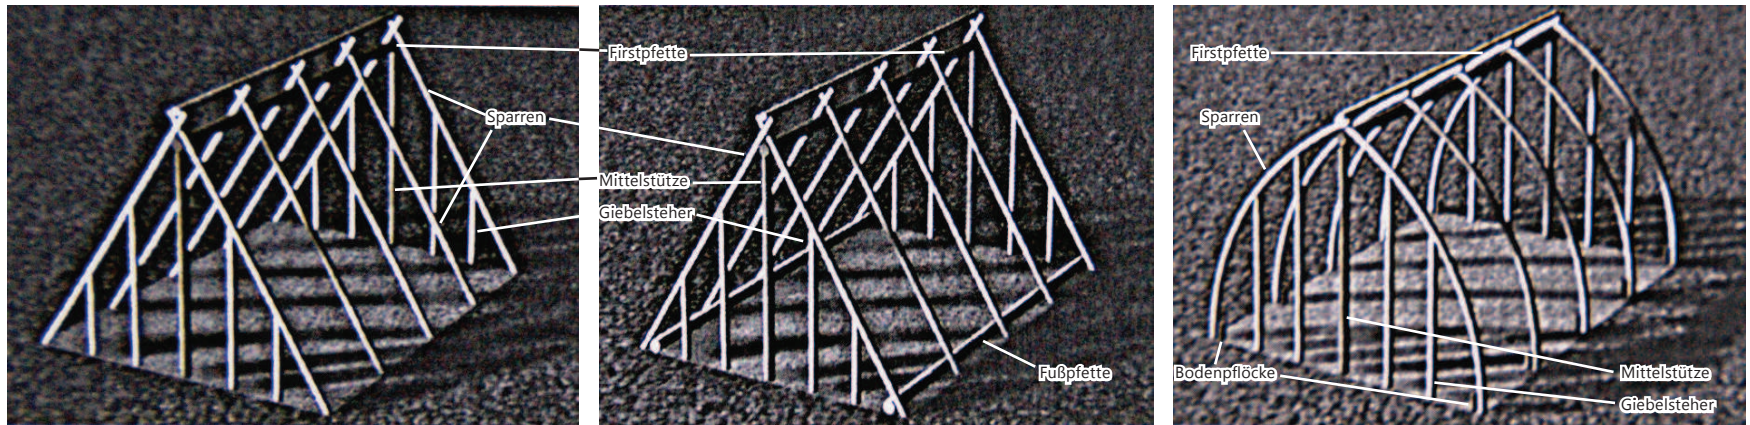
Die drei unterschiedlichen Konstruktionstypen des althawaiianischen Dachhauses (nach Buck): gerade Sparren; gerade Sparren mit Fußpfette; gebogene Sparren mit Bodenpflocken
